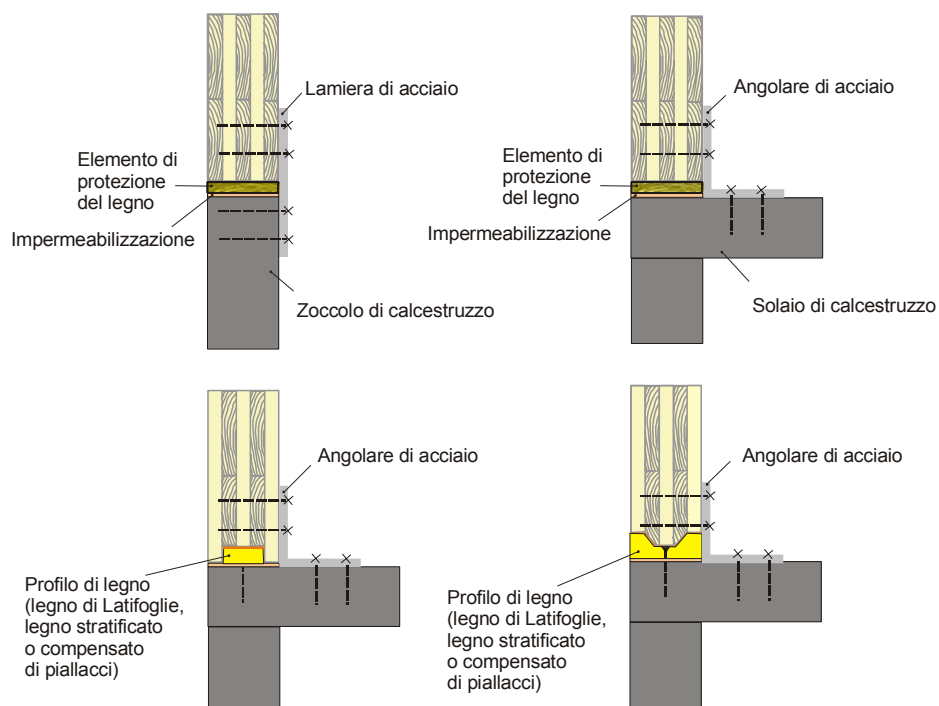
Giunzione parete-fondazione, disposizione di lamiere ed angolari d'acciaio come rinforzo ed ancoraggio per gli sforzi di trazione
